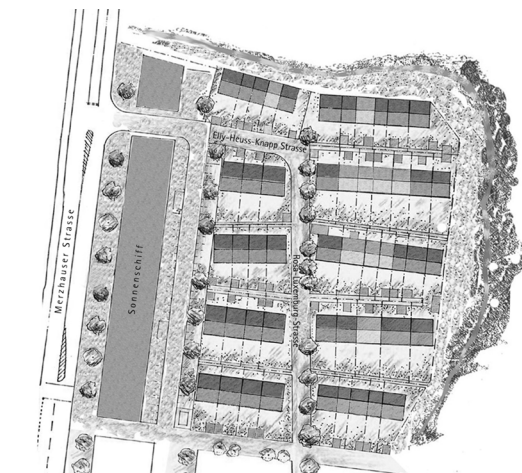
Planimetria generale; Fonte: M. Heinze, K. Voss, 2009;
